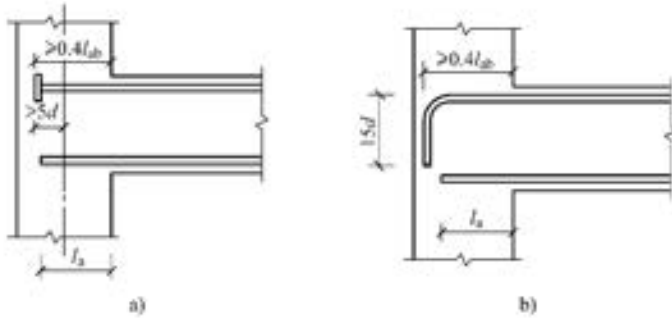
梁上部纵向钢筋在中间层端节点内的锚固
